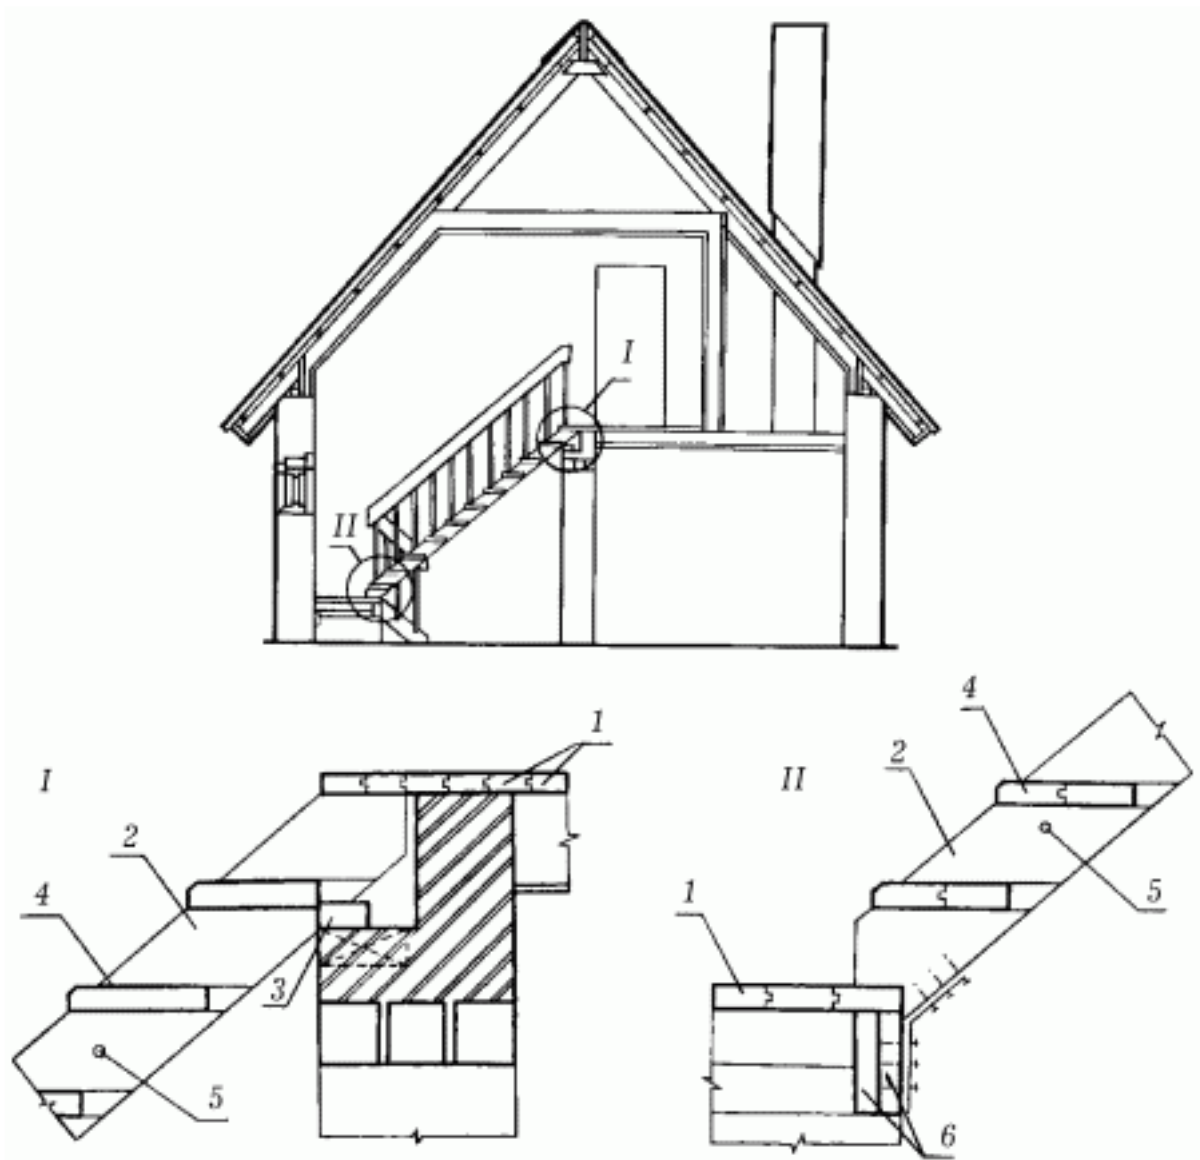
Общий вид и конструктивные элементы двухмаршевой внутренней лестницы: 1 – доски пола; 2 – тетива; 3 – опорный брус; 4 – проступь; 5 – стяжной болт; 6 – балка площадки.
